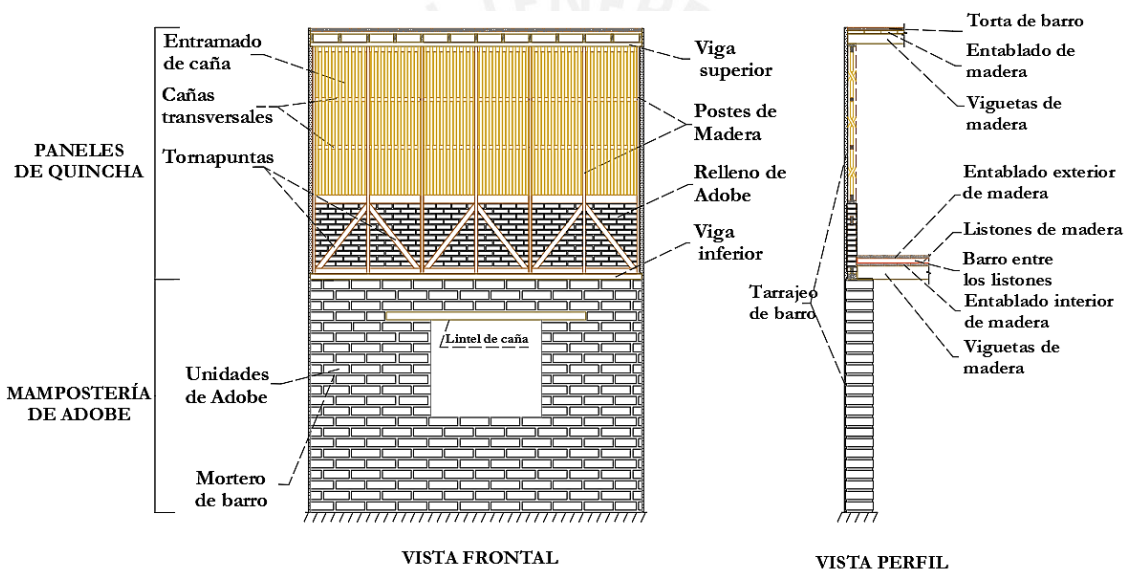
Estructura típica del Sistema Adobe-Quincha (Frontal y Perfil)
